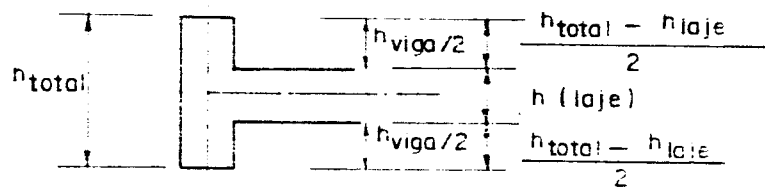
Detalhe da disposição de um elemento de viga ou lintel.
